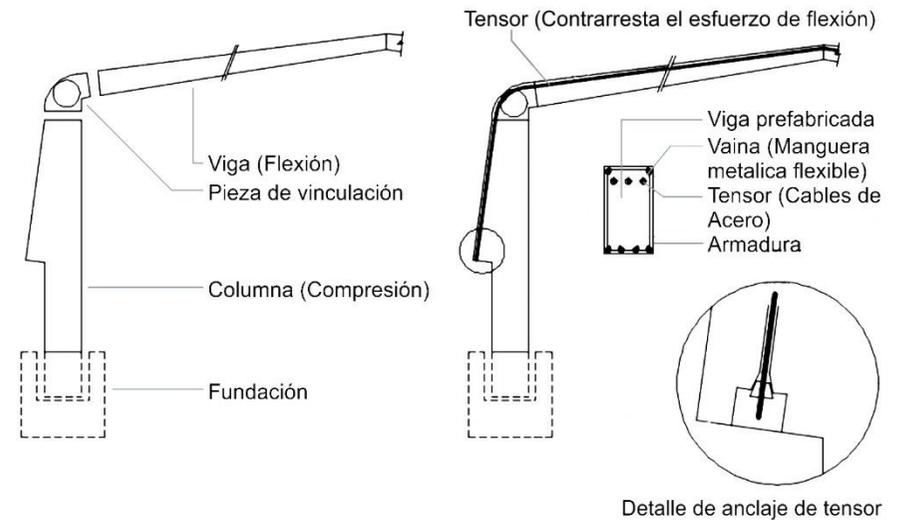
Detalle de armado de un Pórtico de H°Postensado
